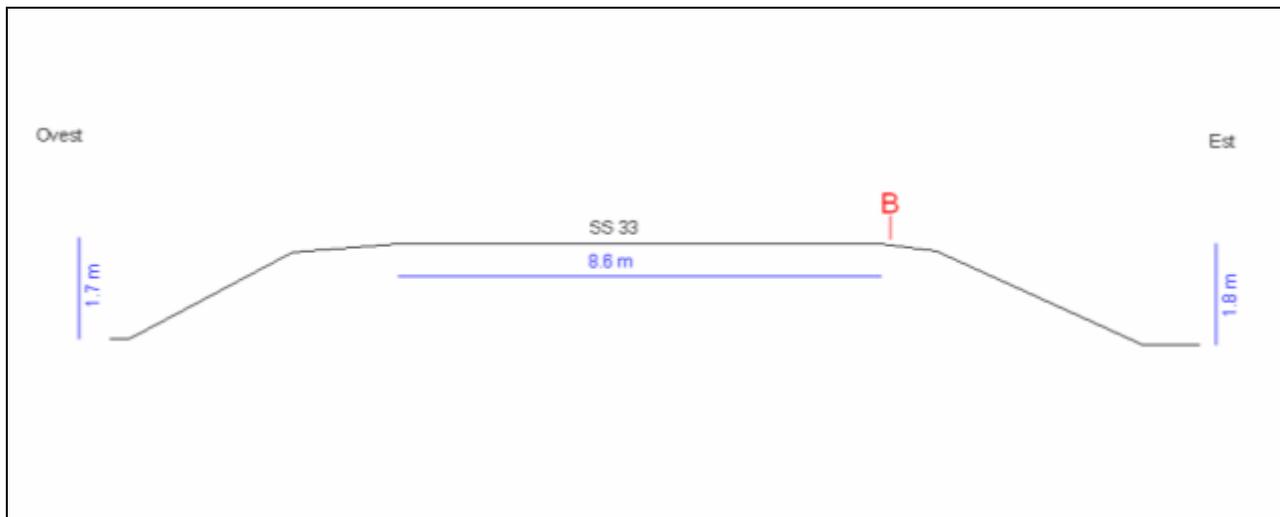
Sezione schematica del tratto stradale di interesse (SS 33)
